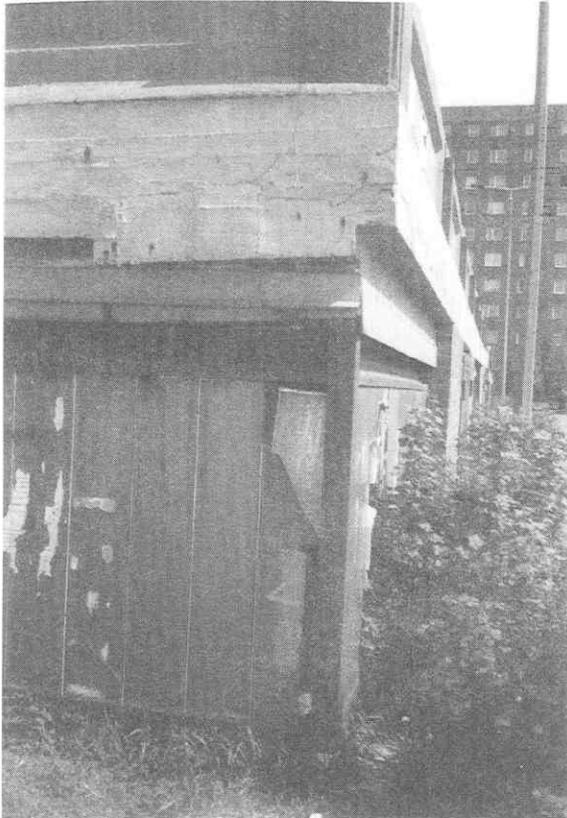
Parkpalette in Erfurt, Nordhäuser Straße
